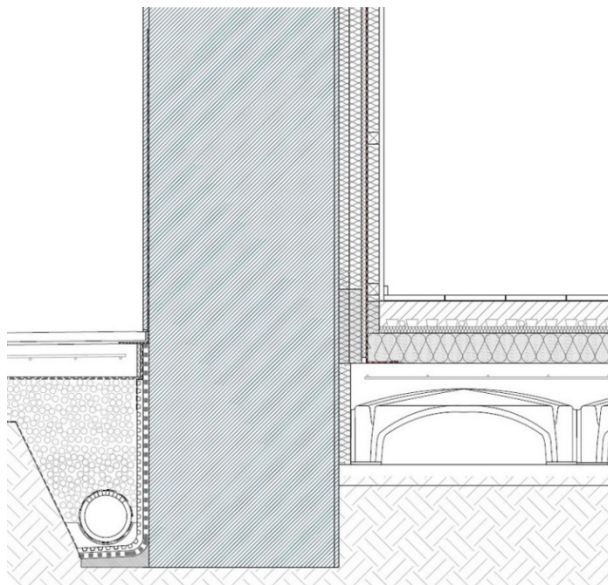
Detalle Constructivo: Encuentro fachada-planta baja.
